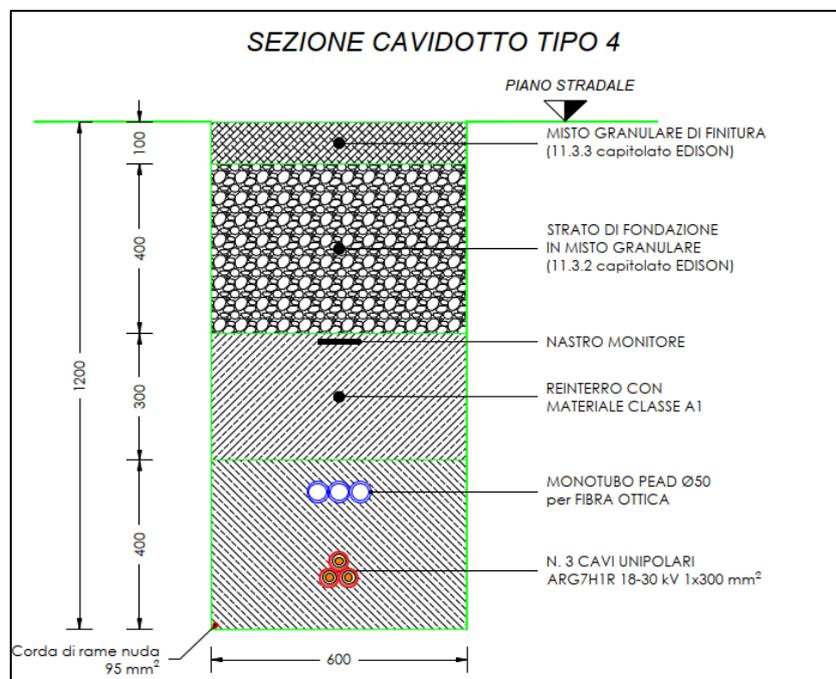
Elettrodotto MT - Sezione di Scavo Tipo 4
